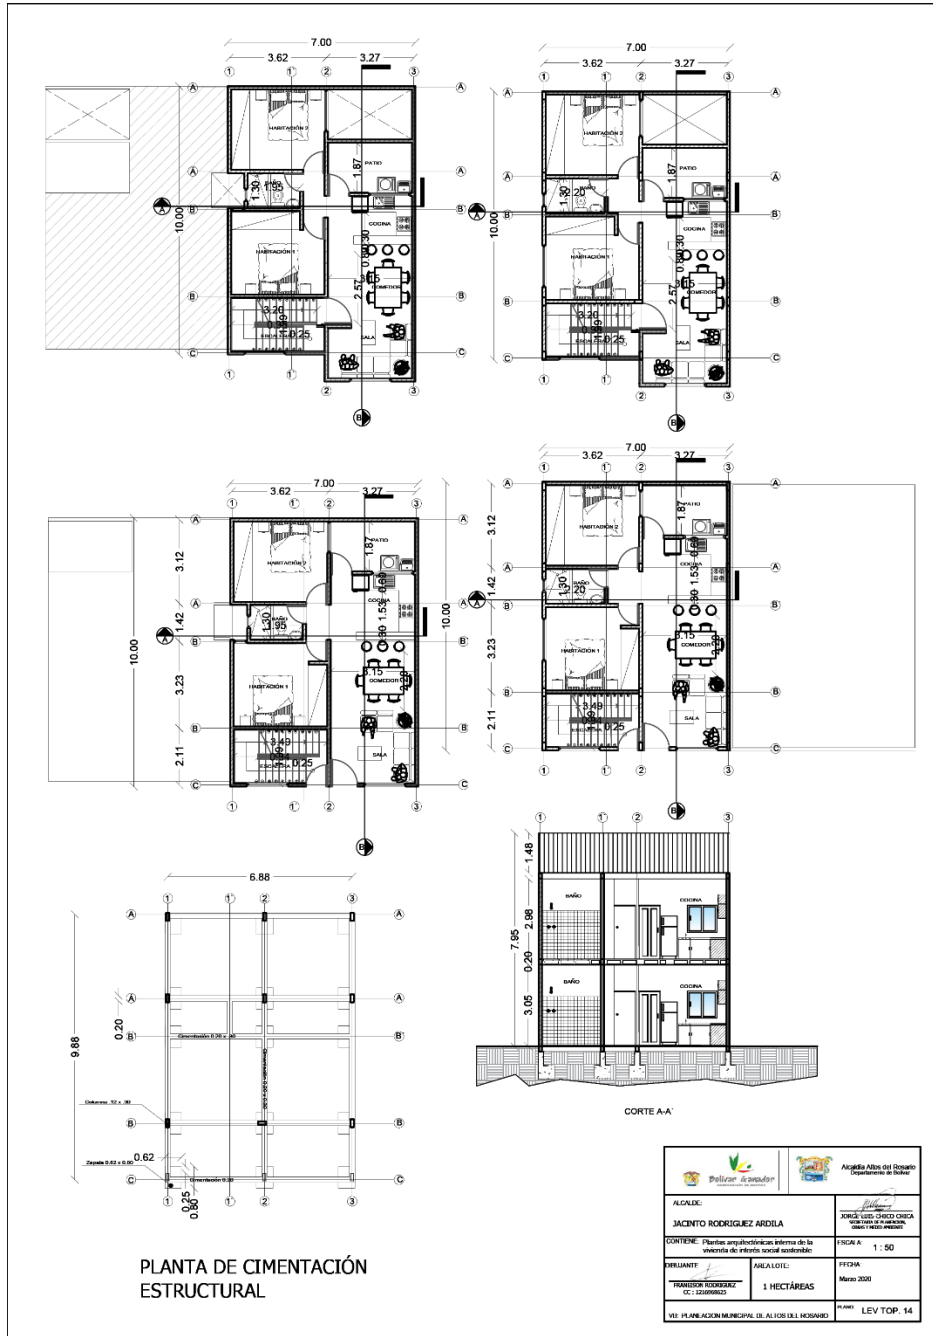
Planta Arquitectónico segunda tipología de vivienda fuente autor
